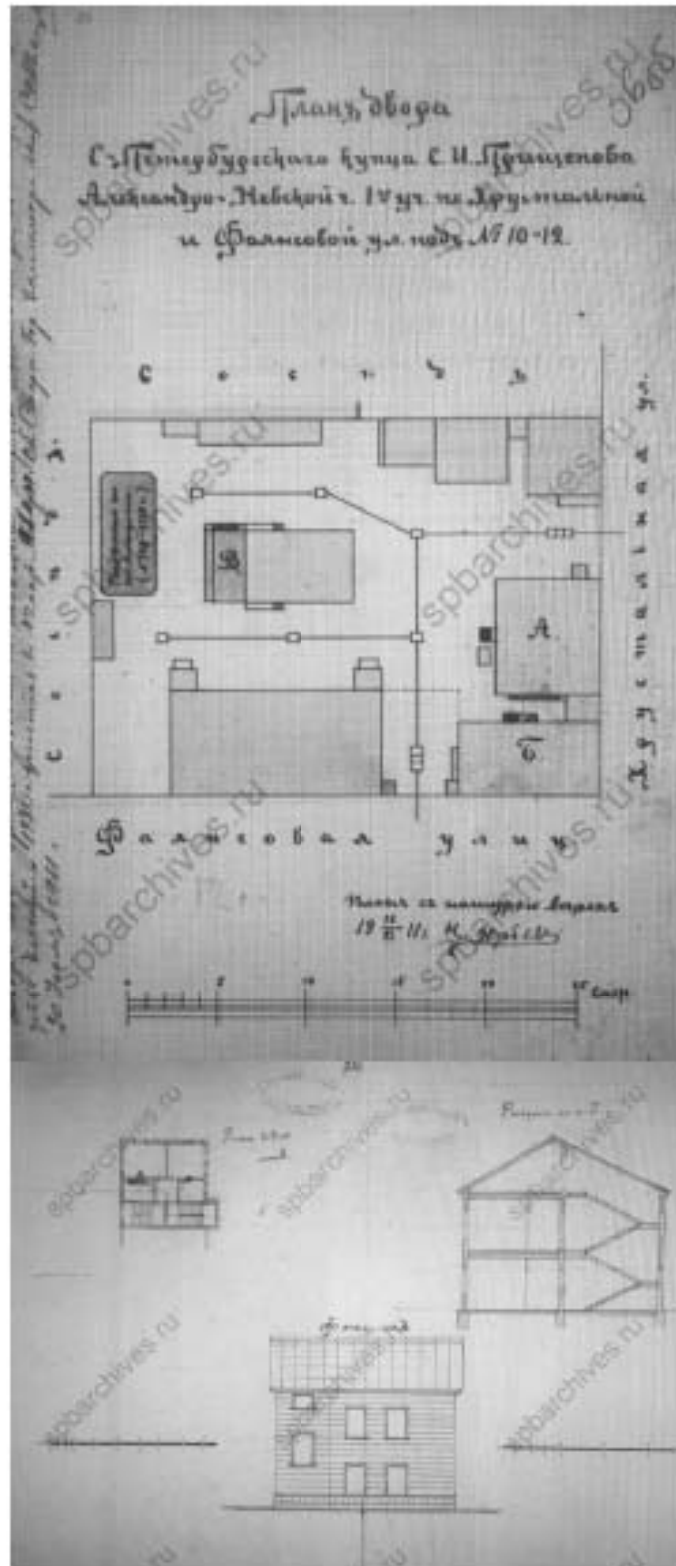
План участка, фасад и разрез здания по адресу Хрустальная ул., 12
